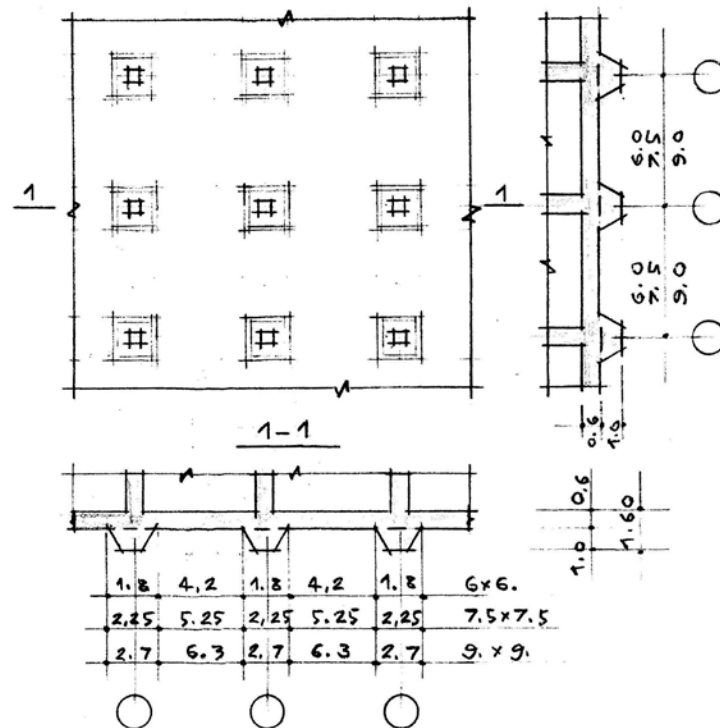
План фундаментов: фундаменты – пирамидальные, конические усеченные и неусеченные для сетки 6 х 6,0 м
